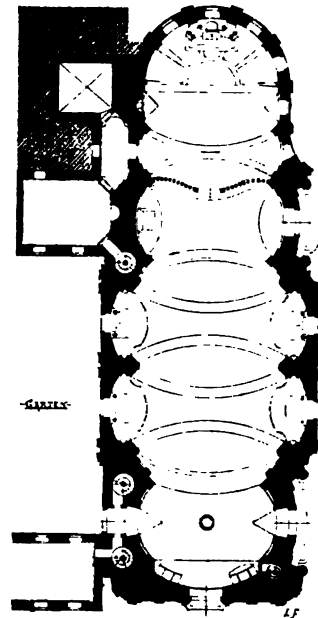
Grundriss von St. Margareth in Brschevnow
